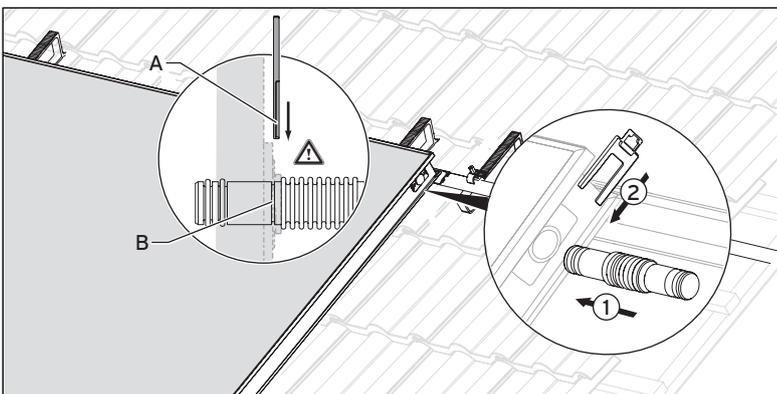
Collocazione dei pezzi di collegamento (disposizione adiacente del campo)
